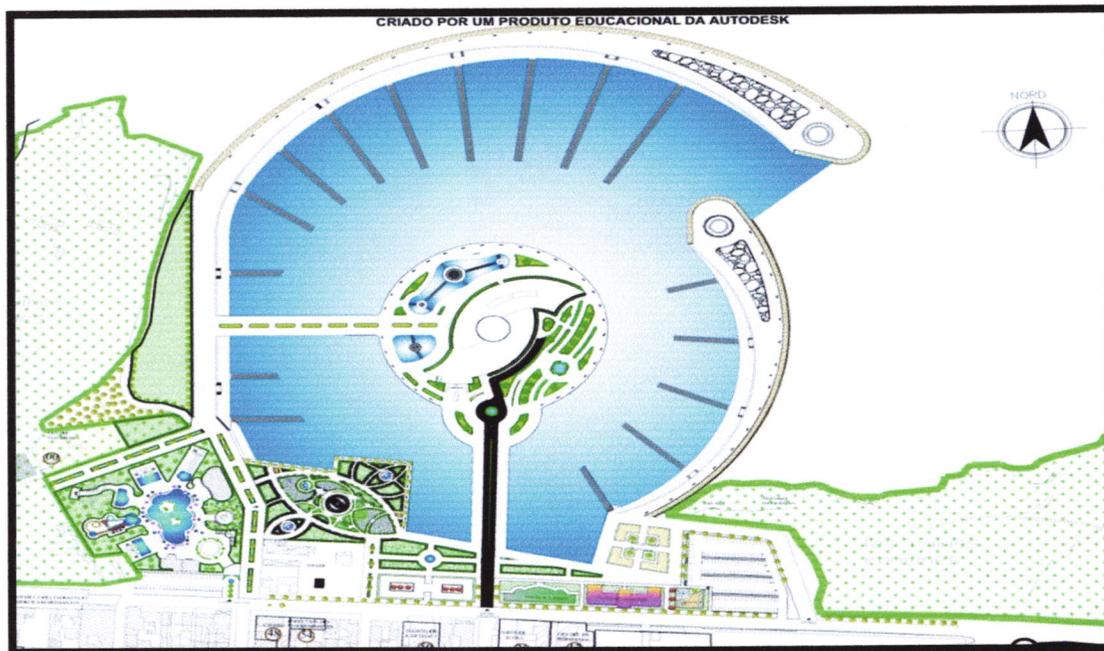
du plan d'aménagement final (Source : support PDAU+travail de l'auteur)
